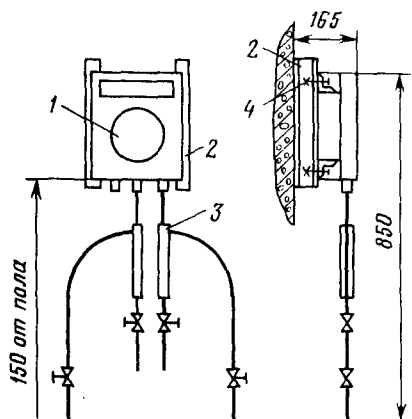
Установка самопишущего двухзаписного прибора давления на стене:
